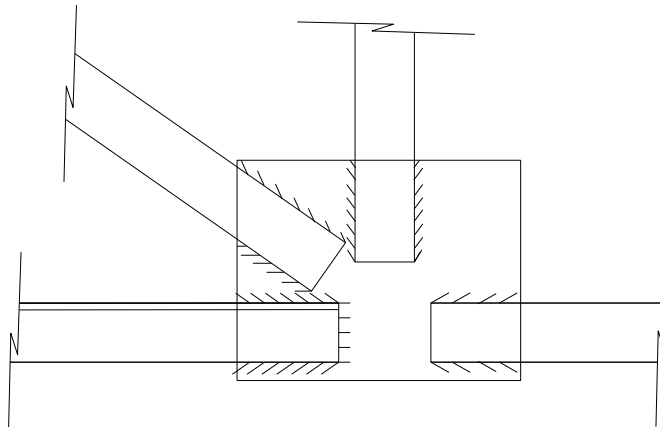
Conexión soldada en todo su perímetro con la placa de conexión.
